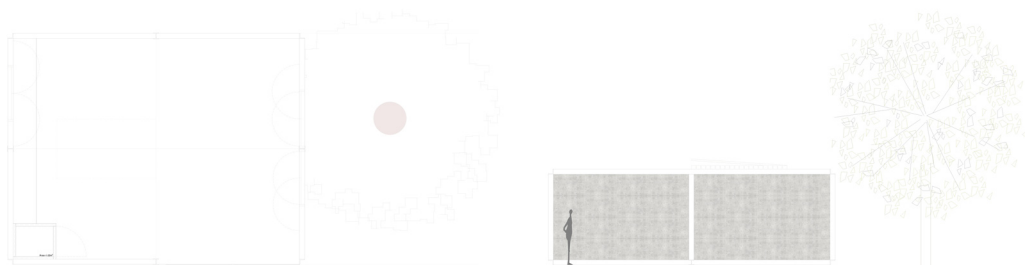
Planta e alçado das oficinas do estaleiro naval.
